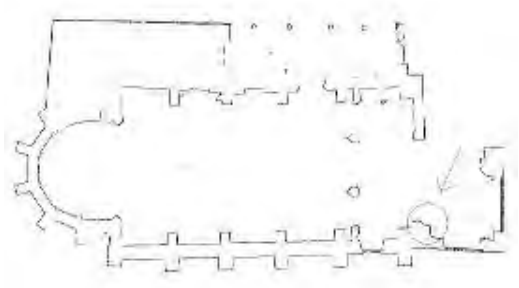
Extracción de la muestra. Imagen tomada por los autores. Planta del templo
